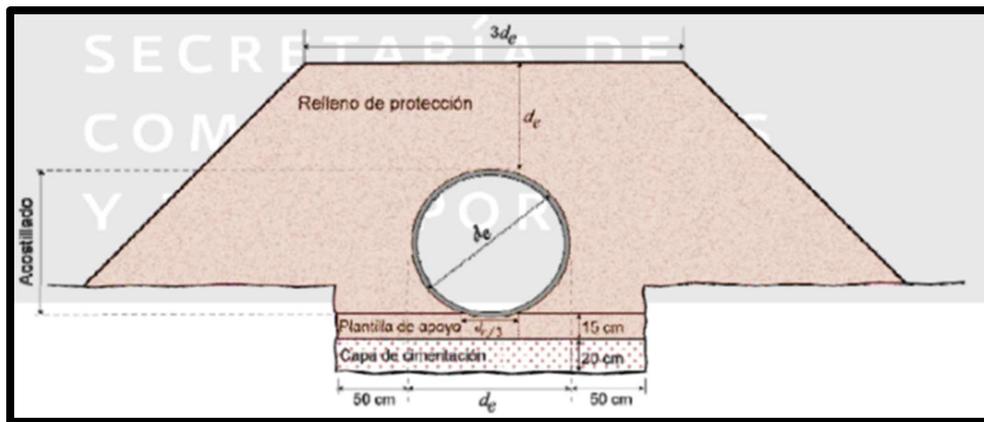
Relleno de alcantarilla en sección de terraplén.
